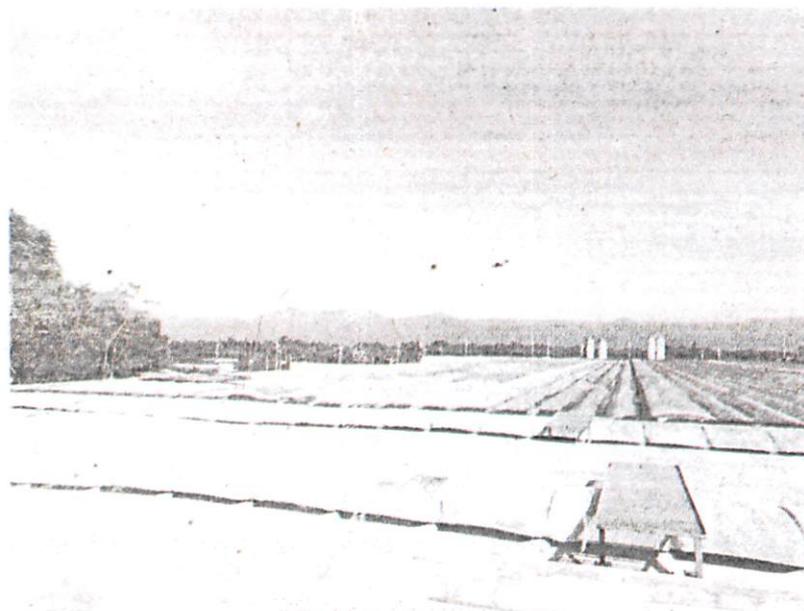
Vista Geral do telhado do supermercado vistoriado.
